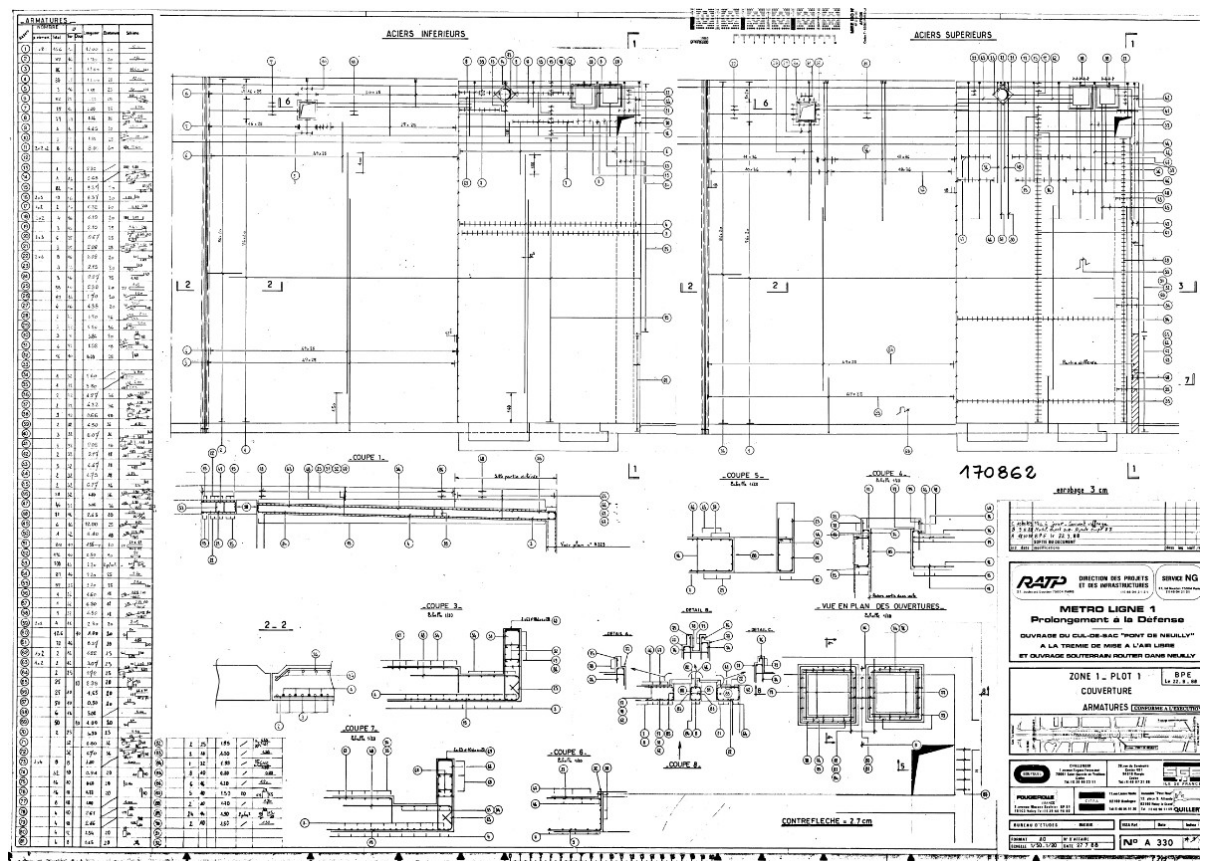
Ferrailage traverse 1b (à droite) et 1a (à gauche)_plan 170862
